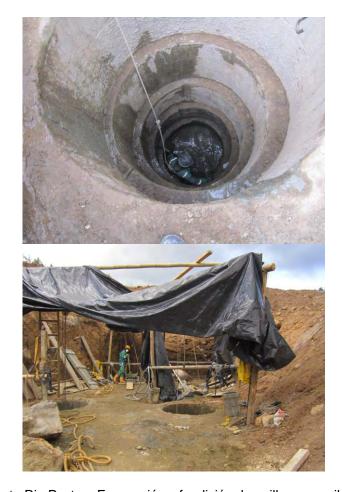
Puente Rio Pasto – Excavación y fundición de anillos para pilotes de cimentación
